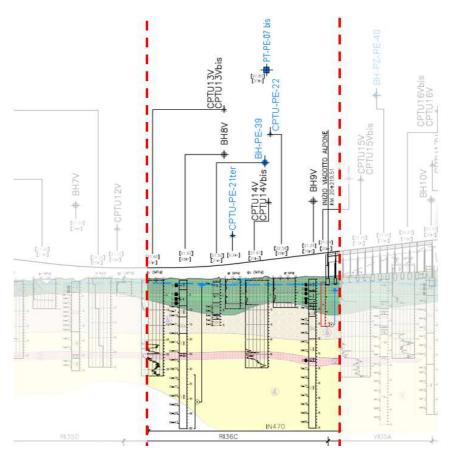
Profilo Geotecnico Rilevato RI36C, estratto dal Profilo Geotecnico Generale (Doc. Rif. [7])
